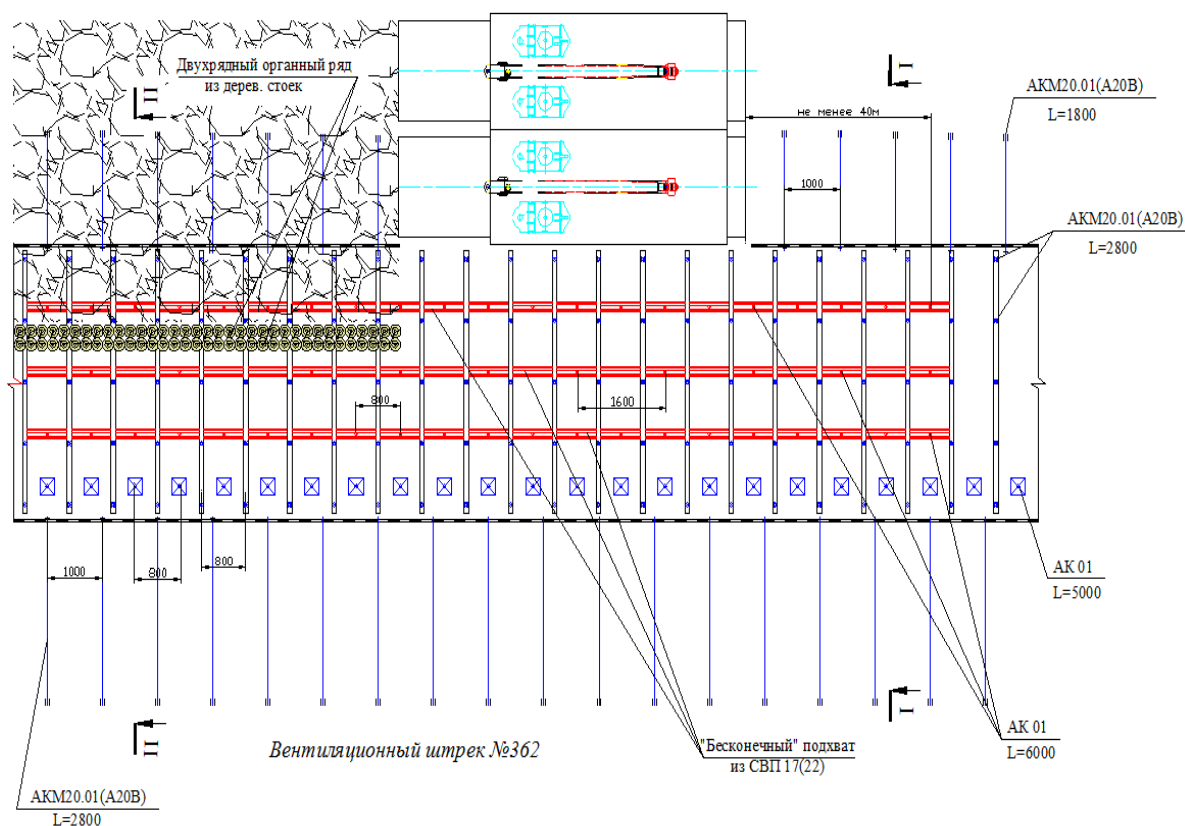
Схема усиления крепления вентиляционного штрека № 362
